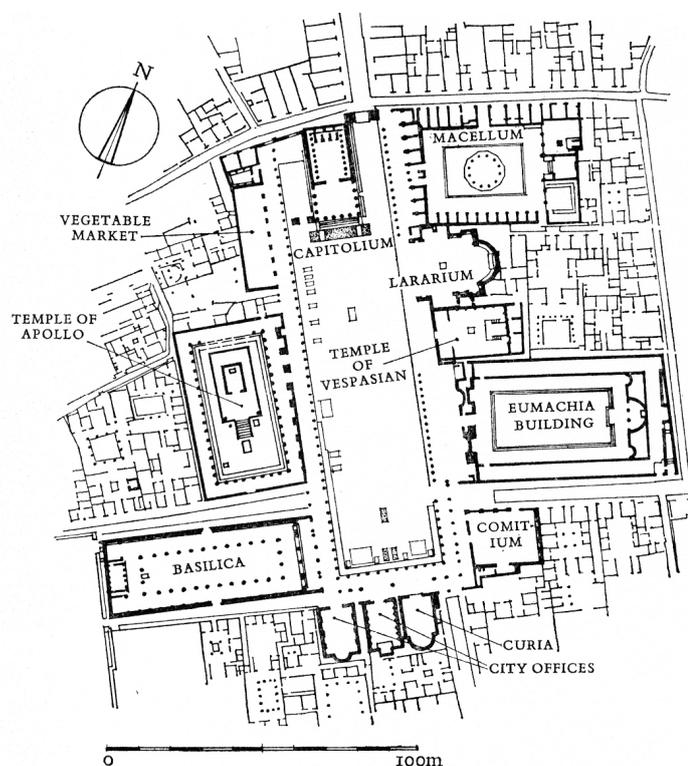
Planta de Pompeia, em reconstrução no ano de 79
